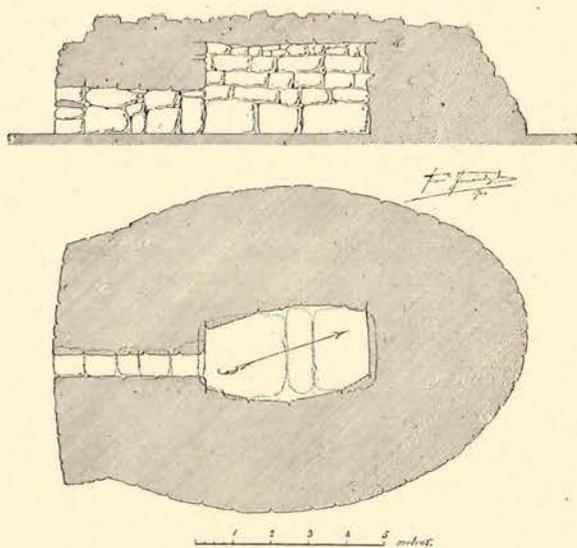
NAUETA MÉRIDIONAL RAFAL RUBY. — Coupe et plan.
